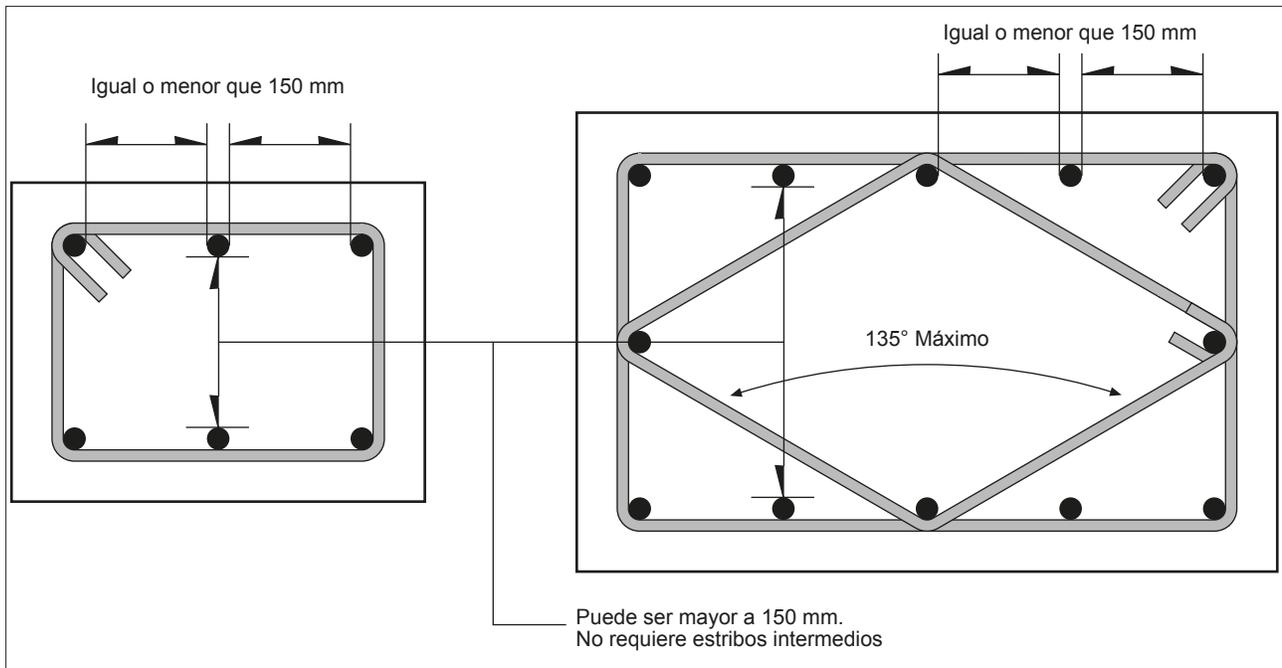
Croquis aclaratorio de las medidas entre barras de columna apoyadas lateralmente.
